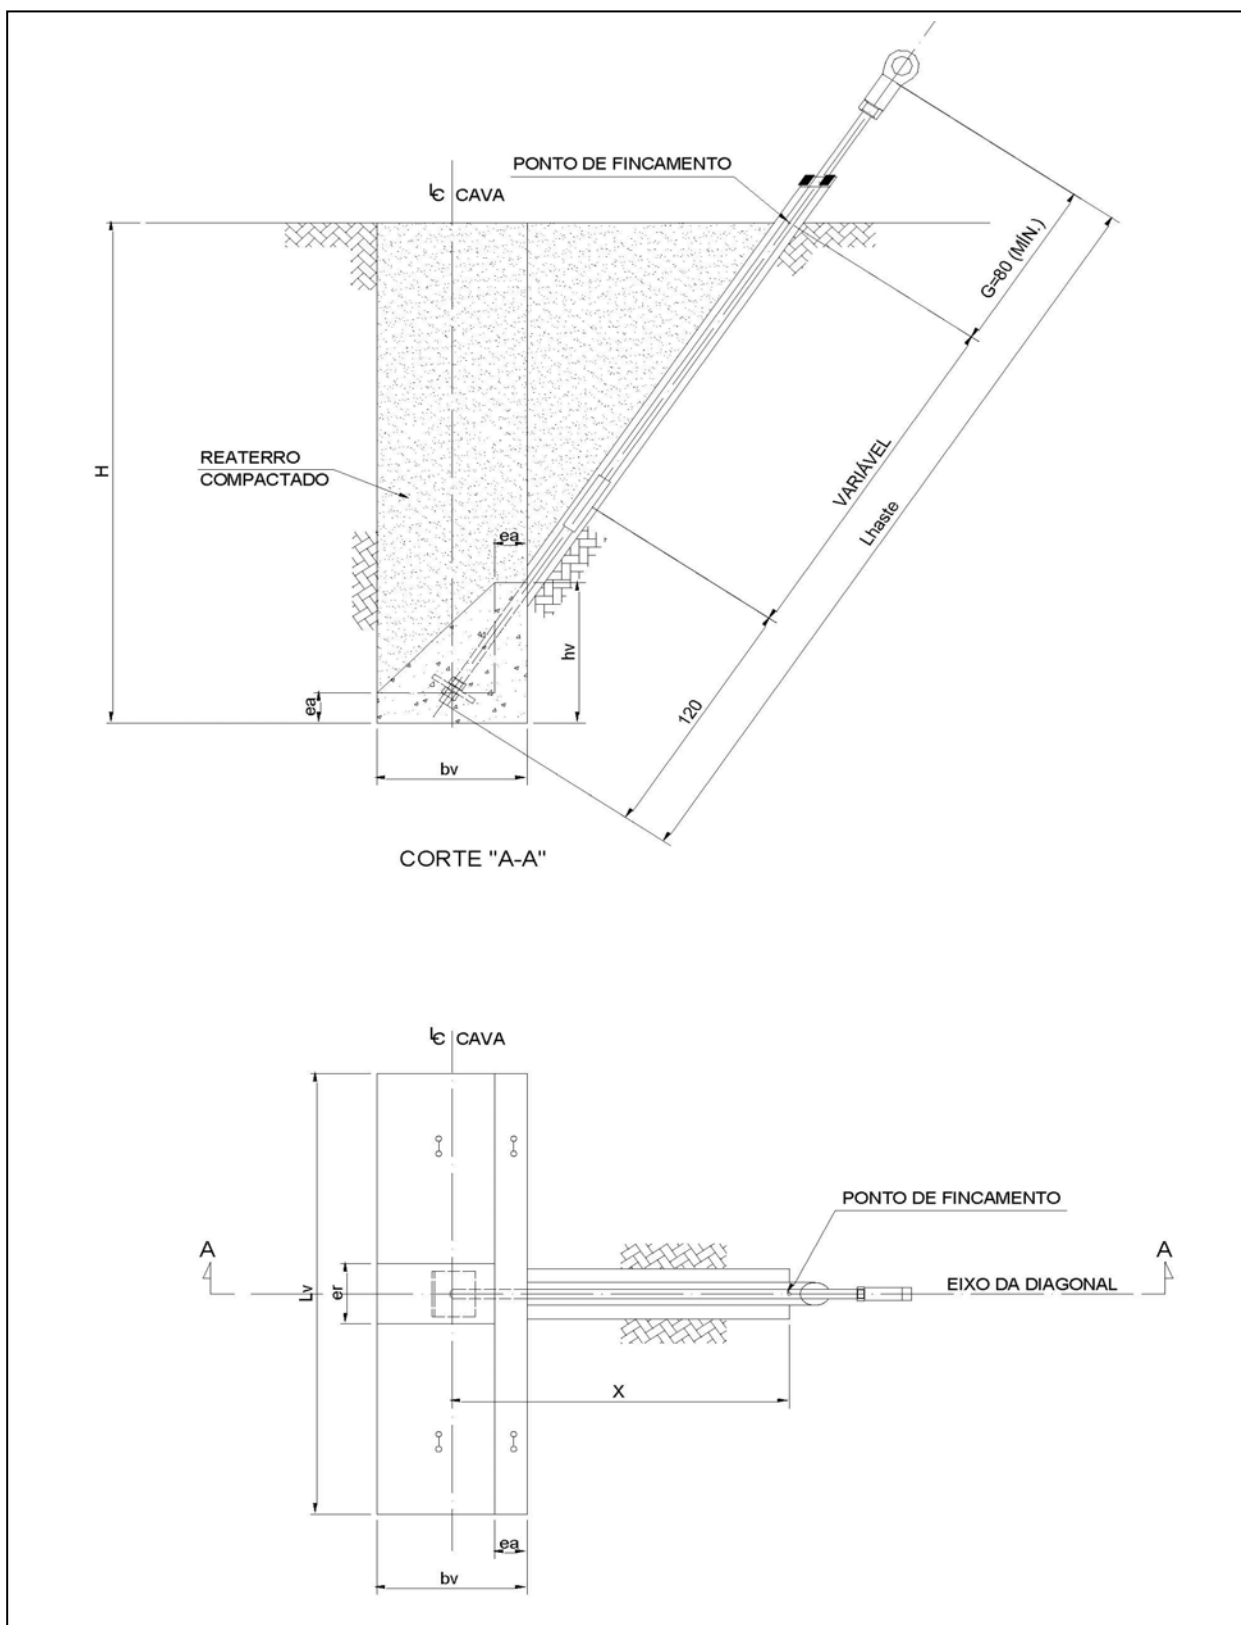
Fundação Tipo Viga L com Haste de Âncora.
